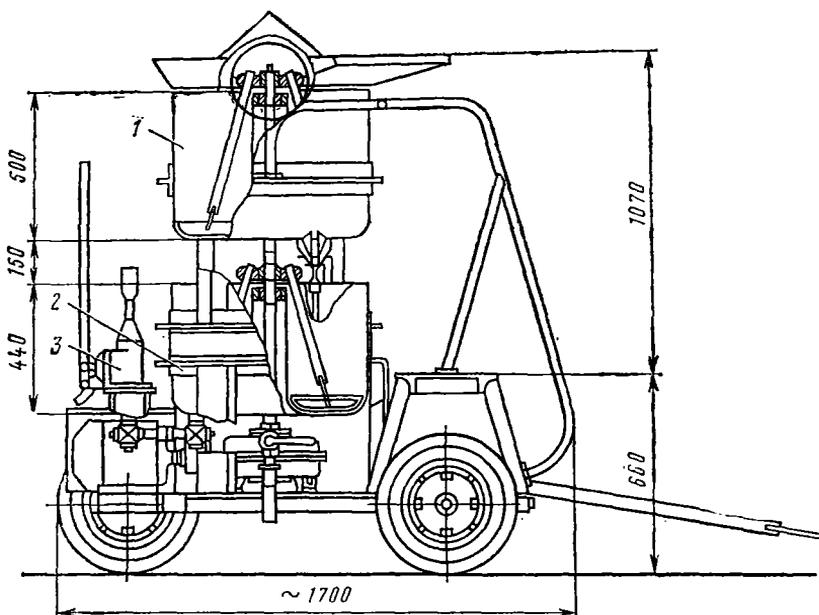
Установка Союздорнии для приготовления и нагнетания раствора: 1 — смешивательный бак; 2 — бак для хранения раствора; 3 — насос для нагнетания
